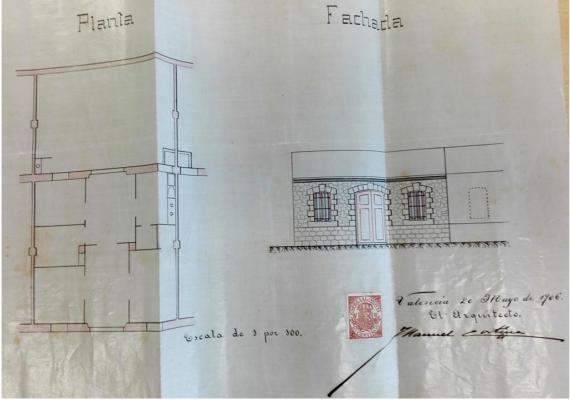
Planos originales de 25 viviendas obreras en C/ Ramón de Castro. Año 1906 (Fuente: Archivo histórico de Valencia)
